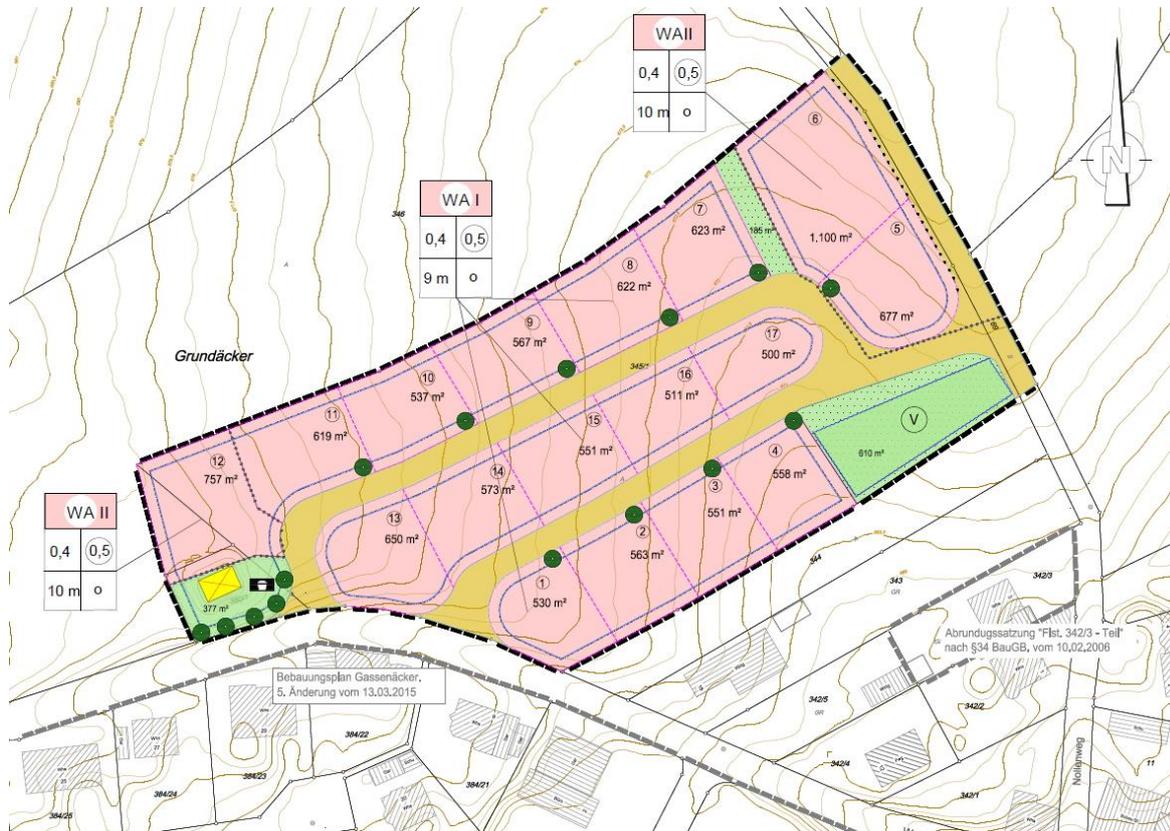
Bebauungsplan Gallmannsweil - Grundäcker
